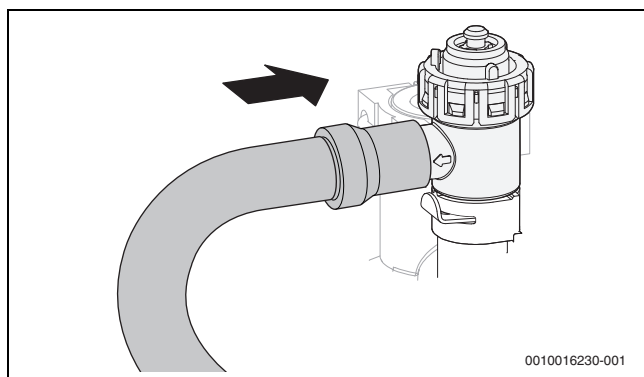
Montaggio del tubo flessibile alla valvola di sicurezza
